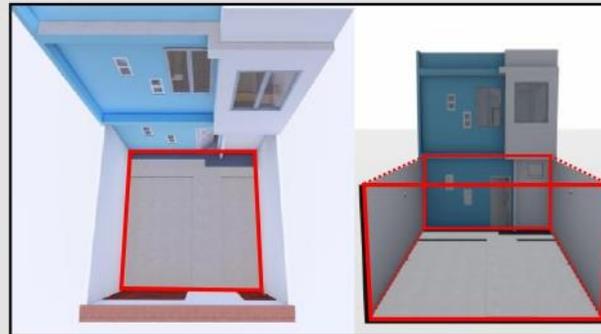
Geometría en planta y elevación del retiro-cochera.
